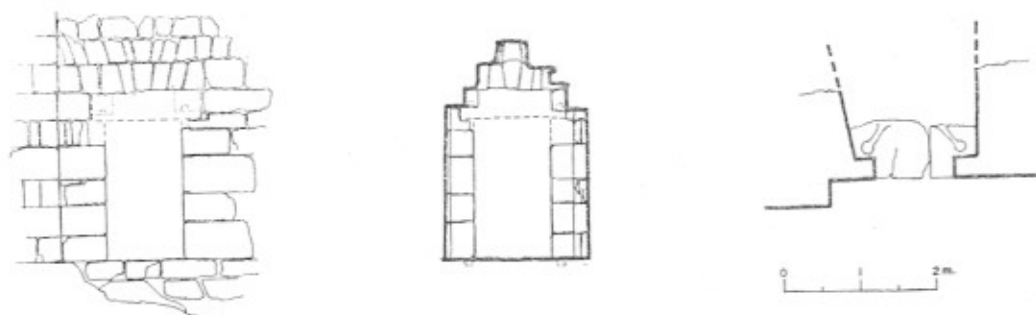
Alzado, sección y planta de la poterna Norte del Castillo de Gormaz
